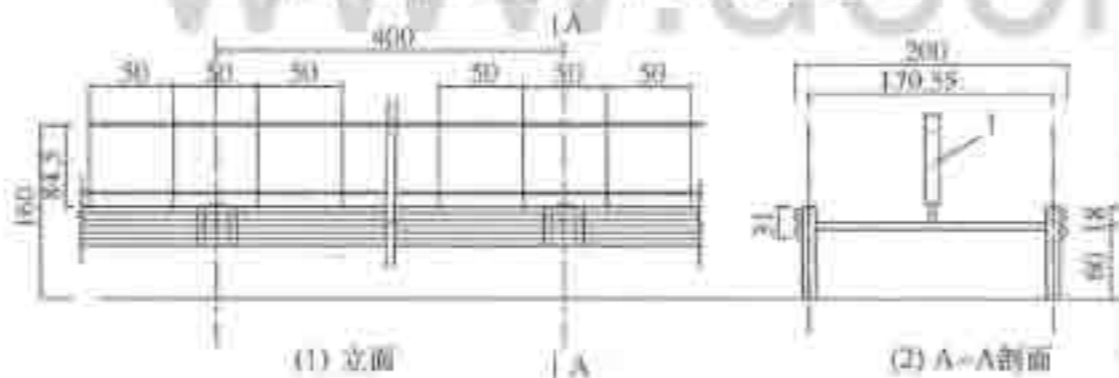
设置于护栏上的防眩板 (尺寸单位: cm)
